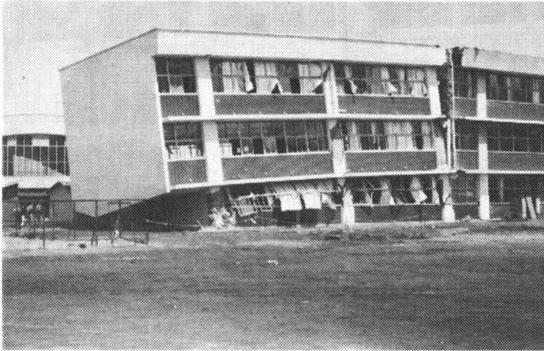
鉄筋コンクリート造の校舎の1階柱破壊による倒壊
